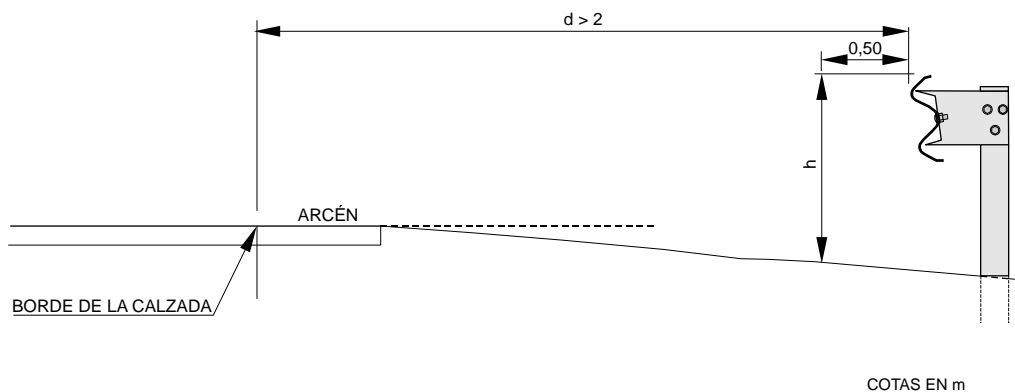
DISPOSICIÓN EN ALTURA DE LAS BARRERAS DE SEGURIDAD METÁLICAS SITUADAS A MÁS DE 2m DEL BORDE DE LA CALZADA
